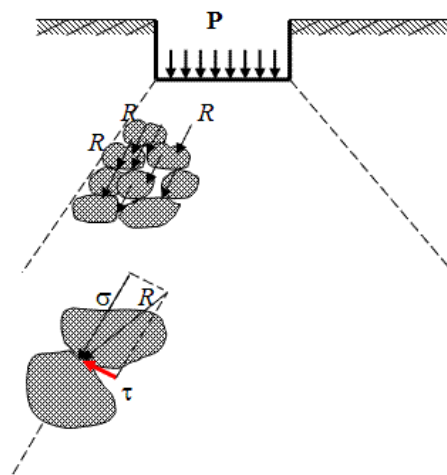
Схема рассеивания напряжений в массиве грунта под подошвой фундамента.
